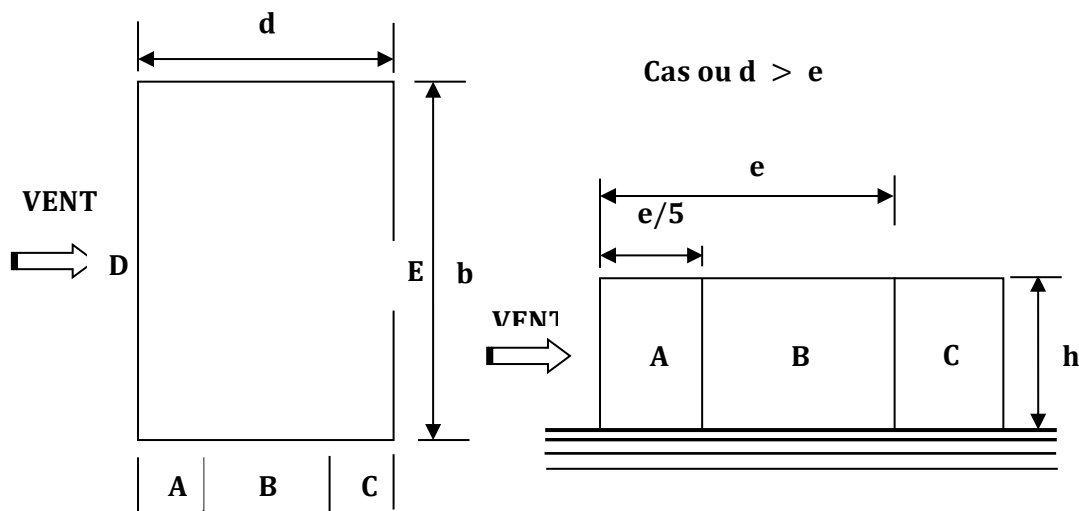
Vue en plan et vue en élévation, sens XY.
